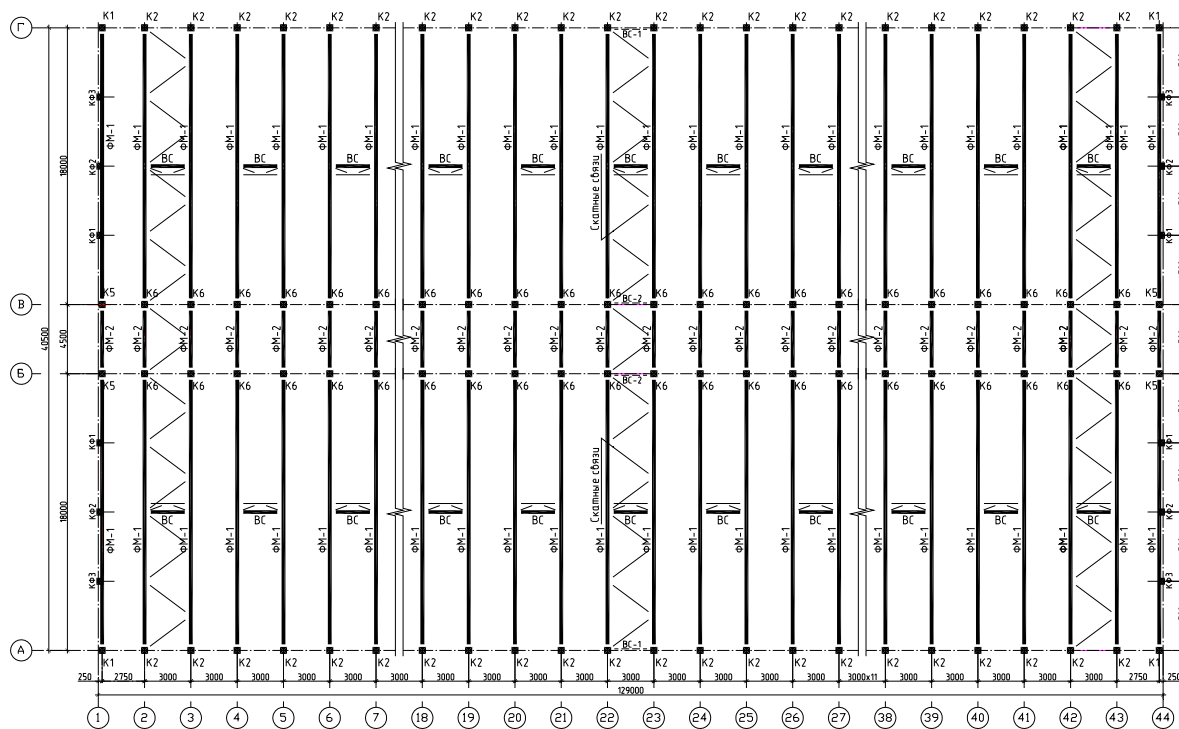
Монтажная схема стропильных ферм со скатными и вертикальными связями
